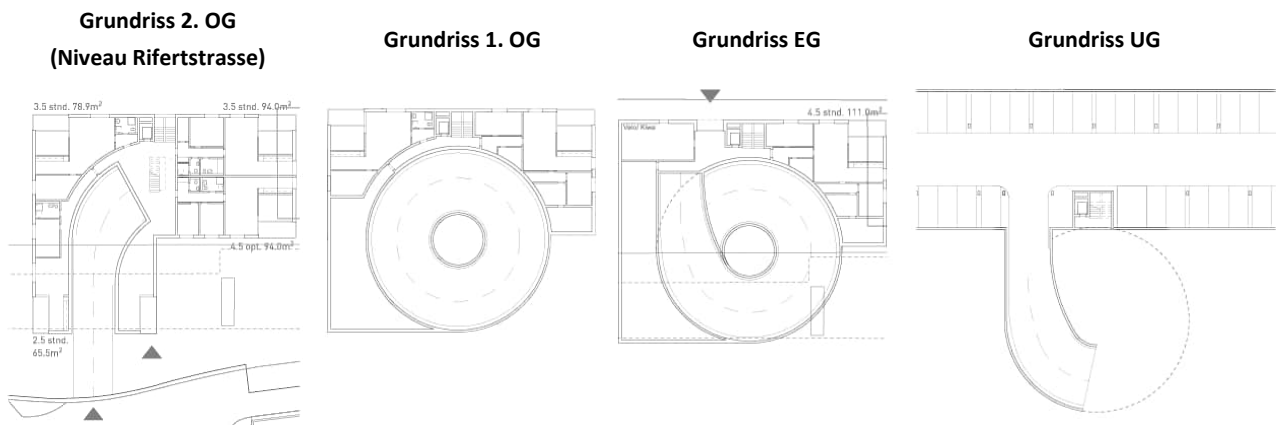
Geprüfte und abgelehnte Erschliessungsvariante ab Wendehammer im Bereich Rifertstrasse 6 und 8, ERP Architekten AG, Baden, Stand Zwischenbesprechung Studienauftrag vom 03.03.2020.
